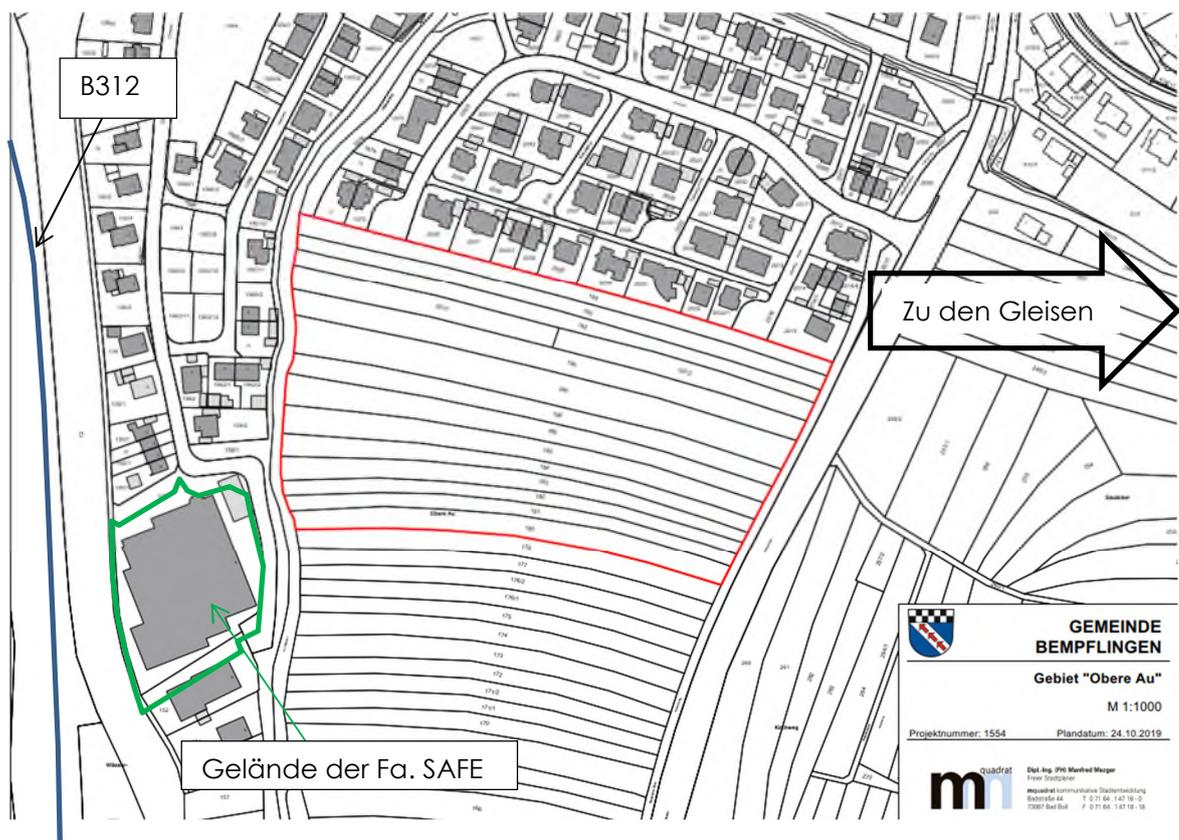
Lageplan zum Vorhaben [22], das Plangebiet ist rot markiert
